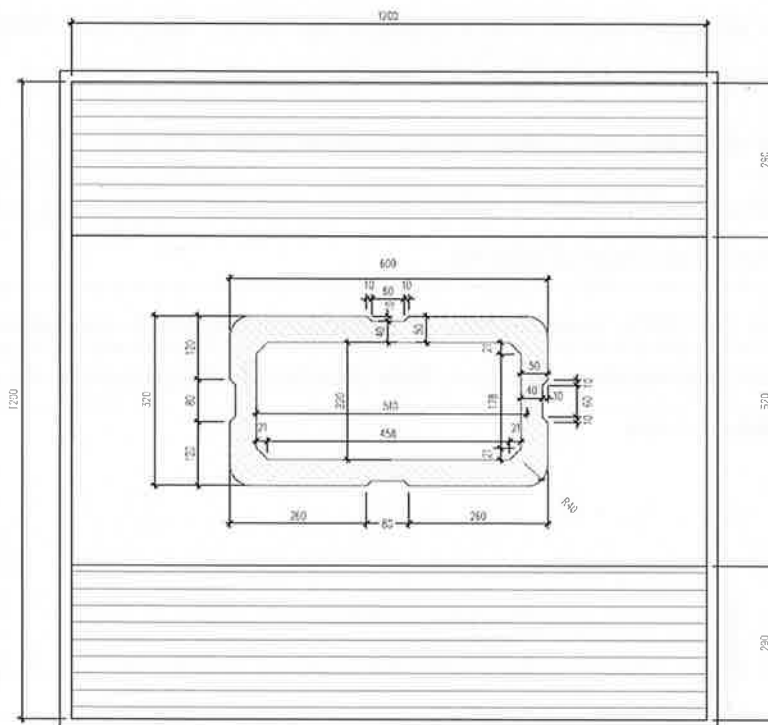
Pianta fondazioni 12x12x3.0m, Bonorva VI01
